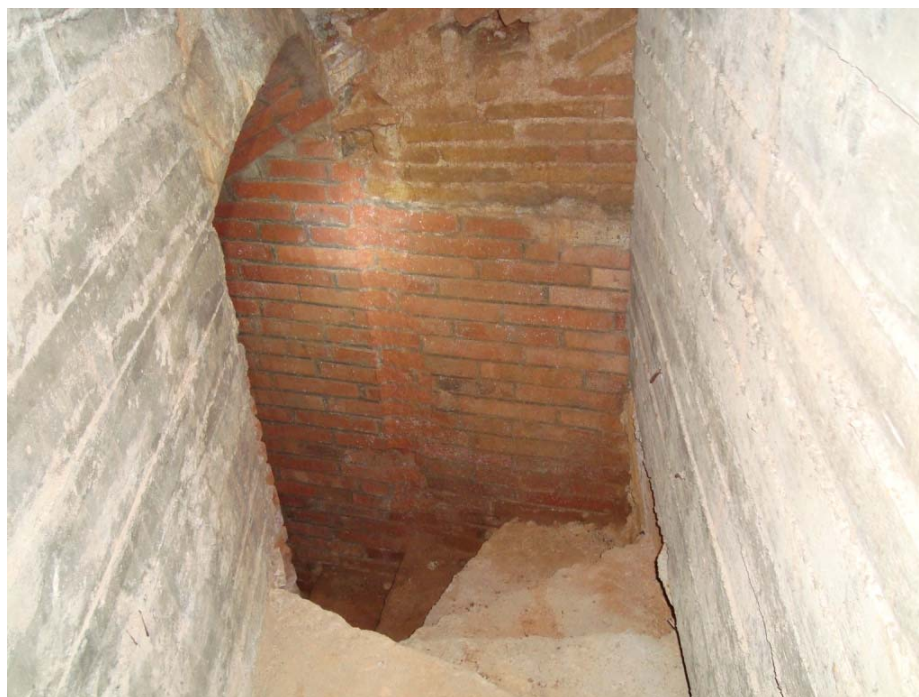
Primer tram d'escales trobat. Vista cap a l'interior de la mina.
